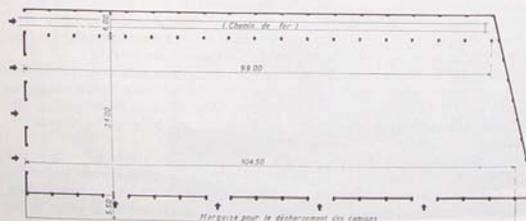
PLAN GÉNÉRAL DE L'ENTRÉPÔT.
